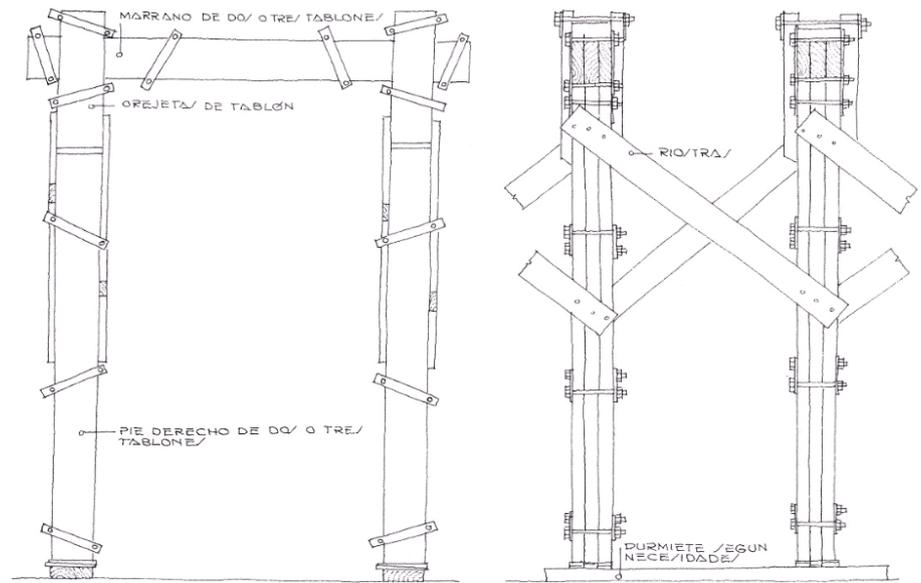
Puente de apeo elemental. Fuente: Espadasin, J. (2009) en [1]
